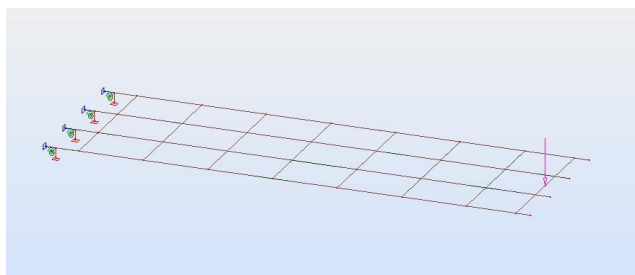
Modelo de barras do provete submetido ao ensaio.
